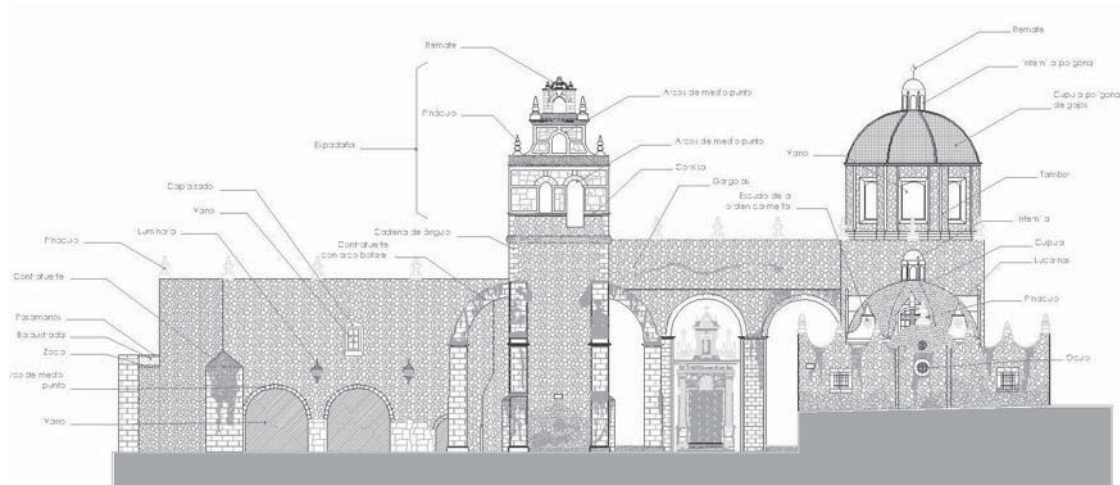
Fachada lateral, plano elaborado por Yadira C. Avila
